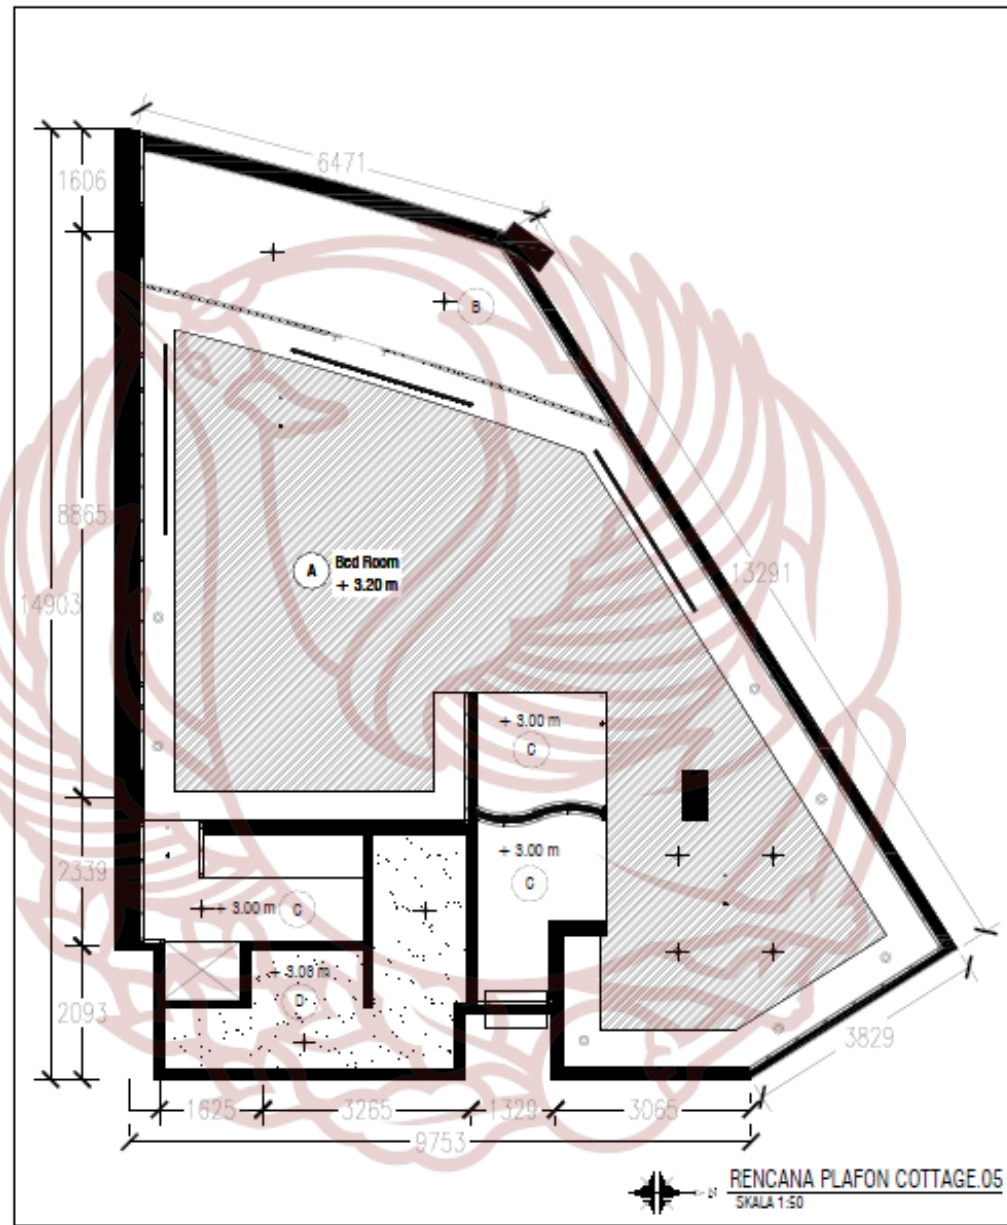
Rencana Ceiling Cottage tipe 3
